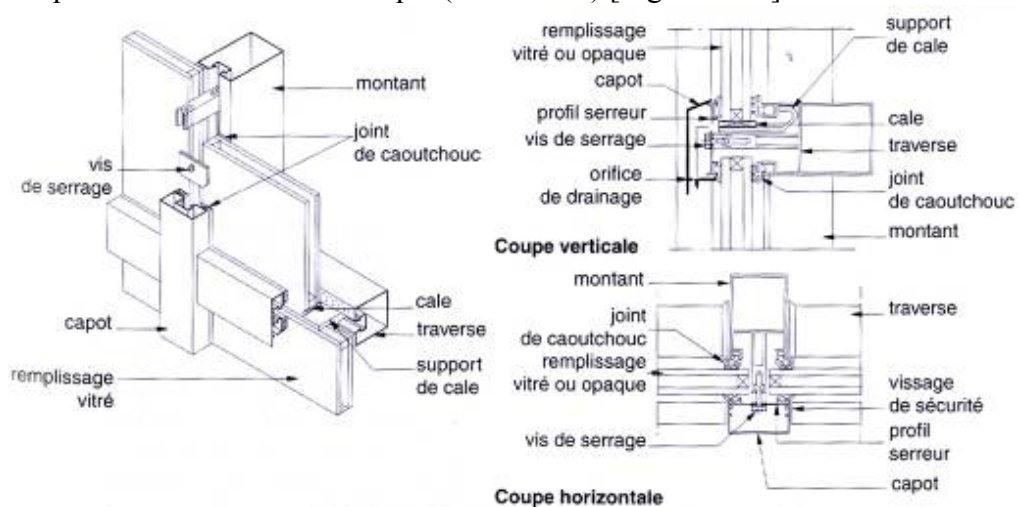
Détail d'une façade VEP [Architectural Systems].
